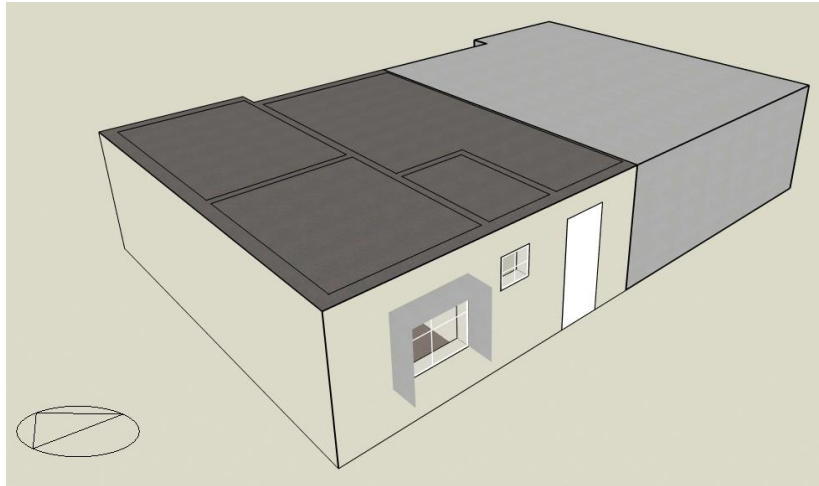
Vista de la protección solar de la ventana de la fachada sur
